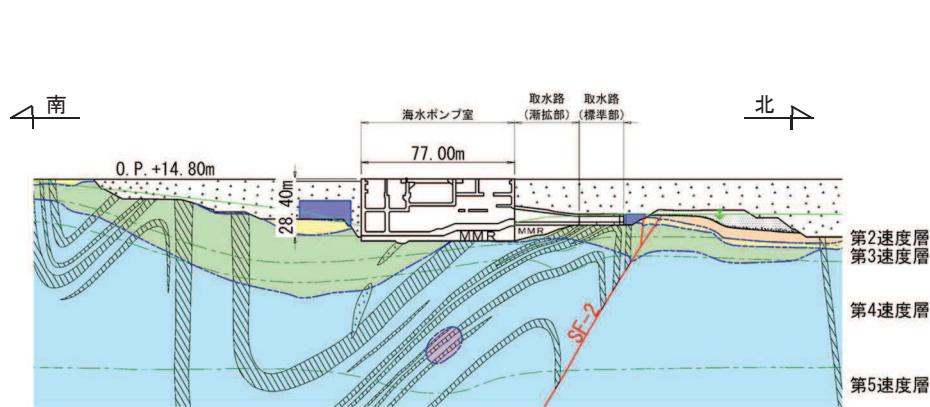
海水ポンプ室地質断面図 (A-A)
